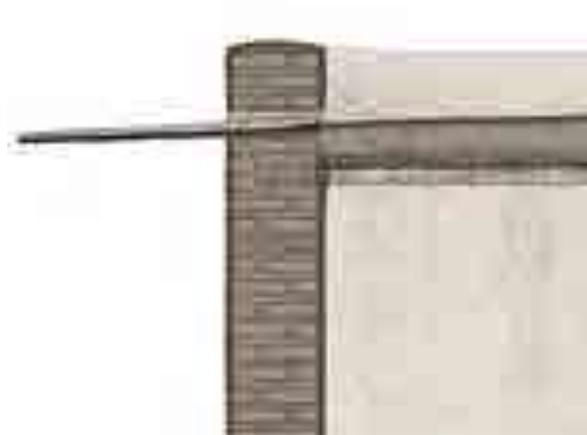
Detalle de remate de cubierta y empotramiento de gárgola de madera en el muro.
